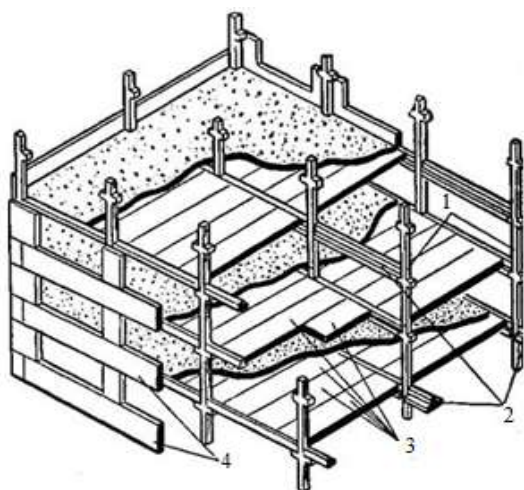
Каркас багатоповерхової будівлі: 1 – колони; 2 – ригель; 3 – плити перекриттів; 4 – панелі зовнішніх стін
